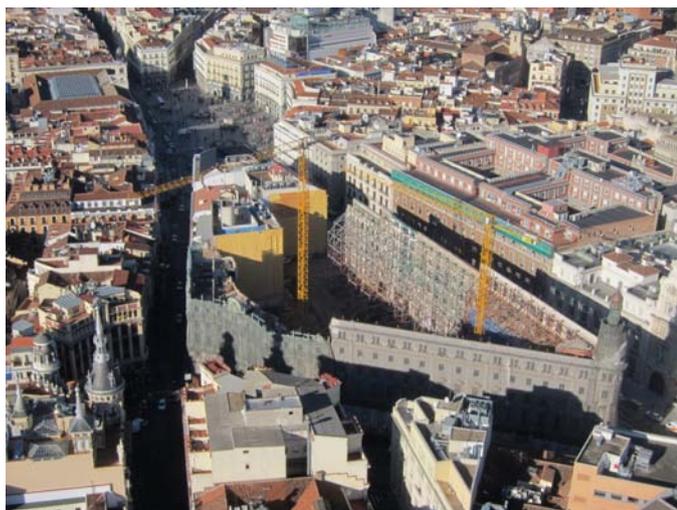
Vista área del conjunto de la manzana tras la demolición de la estructura no protegida
